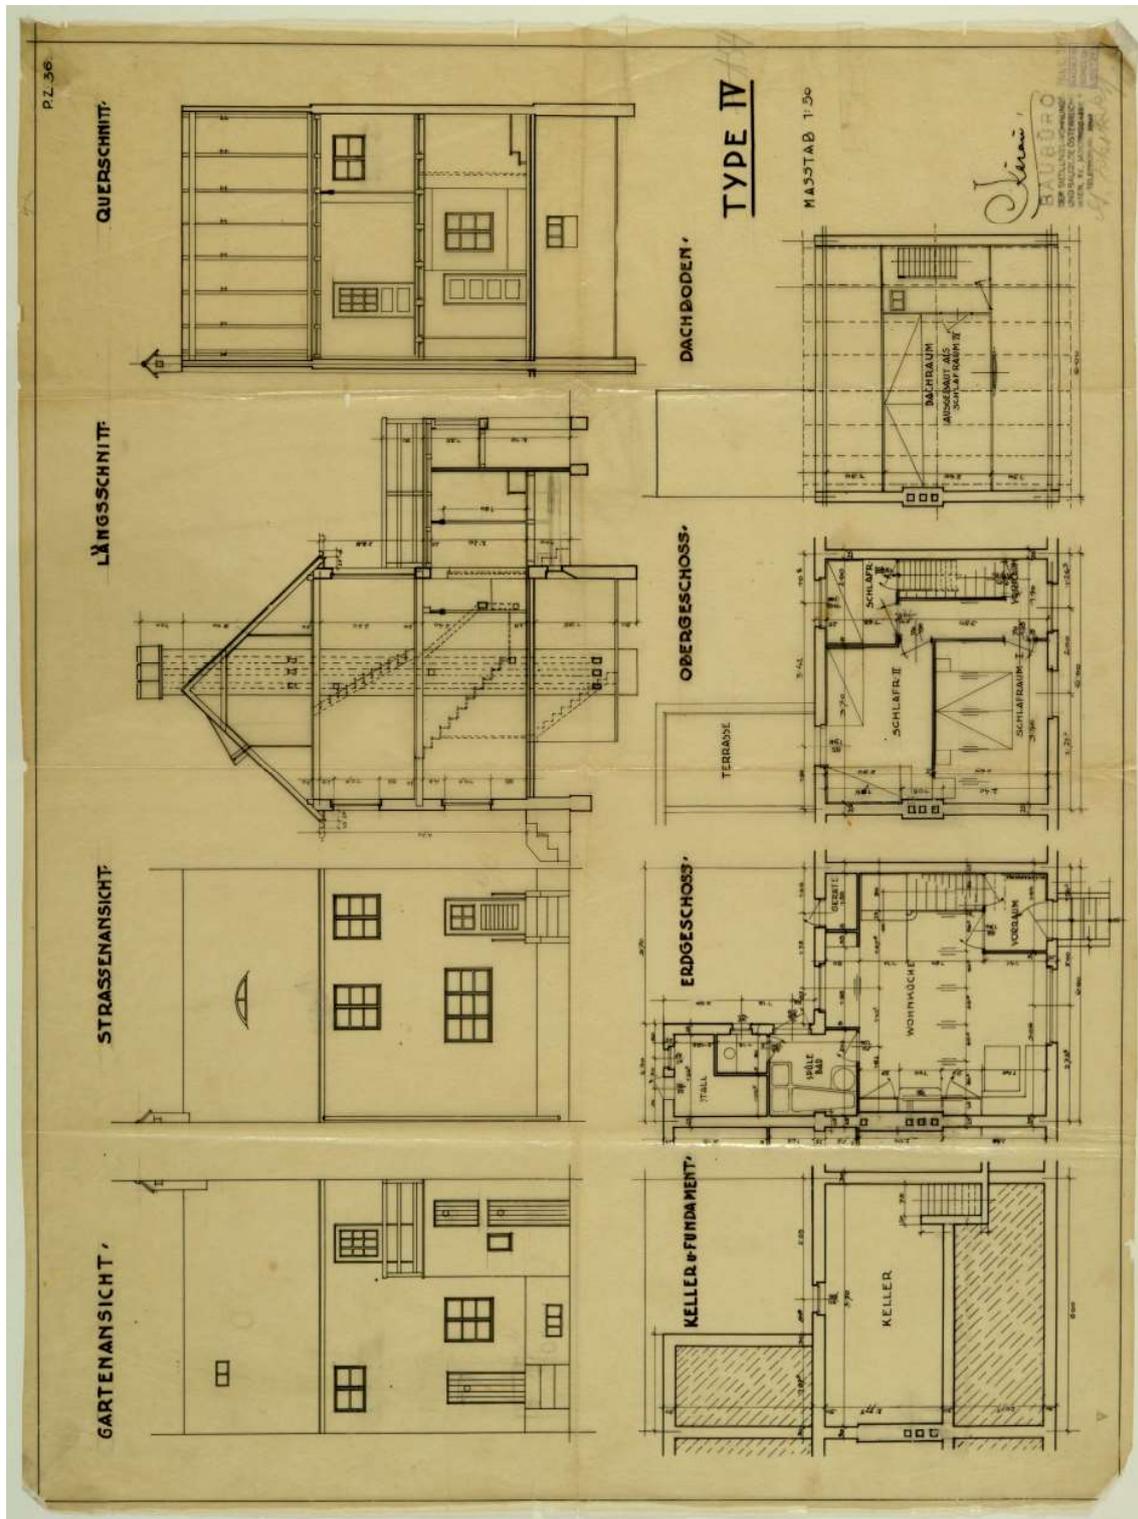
Abb.XLIX:Siedlerhaus Type IV, Grundriss, Schnitt und Ansicht.1922.
